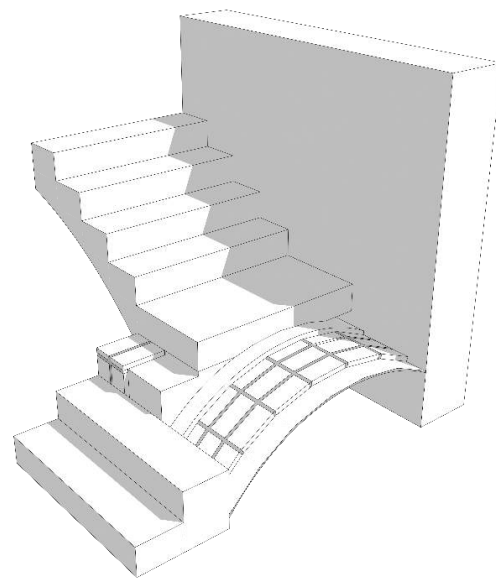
Detalle Constructivo de Escalera. Autor Propio. 2015
